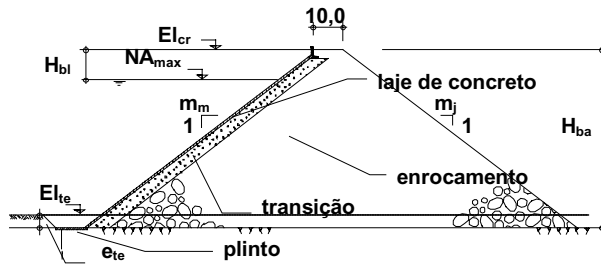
Seção típica de barragem de enrocamento com face de concreto.
